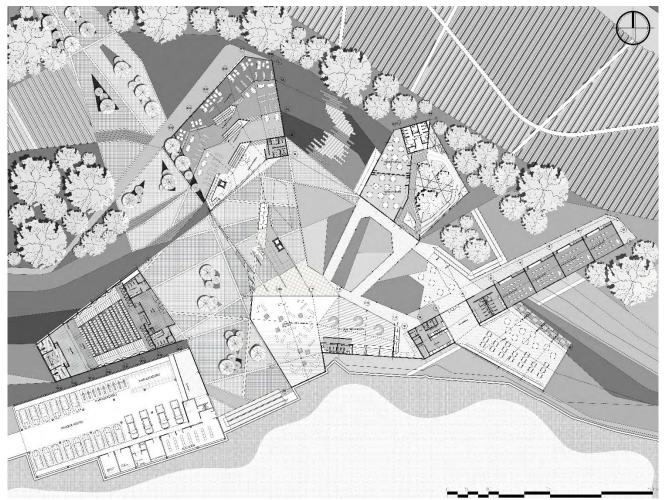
Planta Arquitectónica Nivel 0.00. Fuente: esta investigación.
